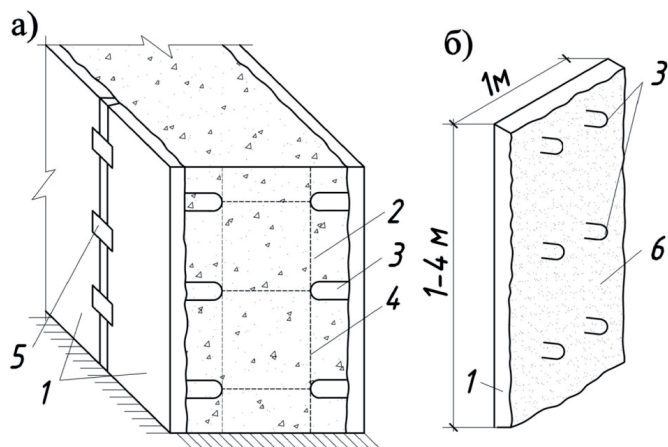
Конструкція тришарових стін: а – загальний вигляд; б – тонкостінні опалубні вироби; 1 – опалубні вироби; 2 – бетон основної конструкції; 3 – анкерні петлі; 4 – армокаркас; 5 – накладка для зварного з'єднання; 6 – активна поверхня опалубки.
